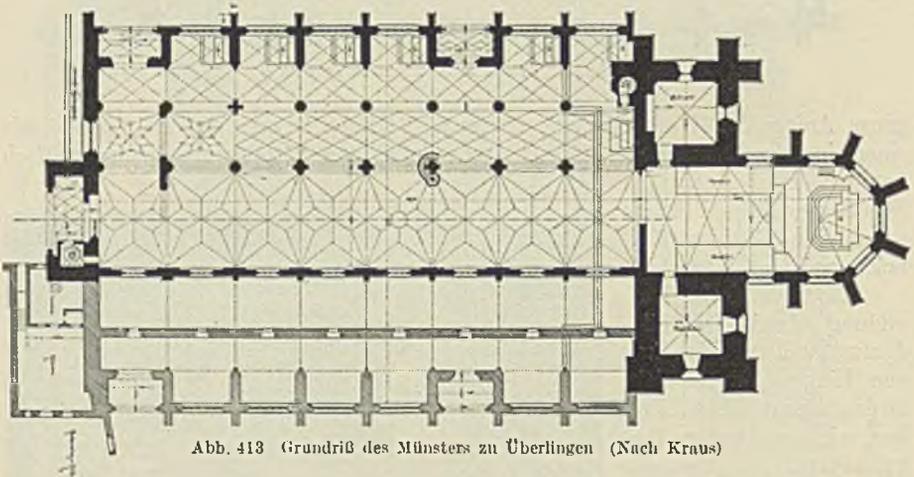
Grundriß des Münsters zu Überlingen (Nach Kraus)
